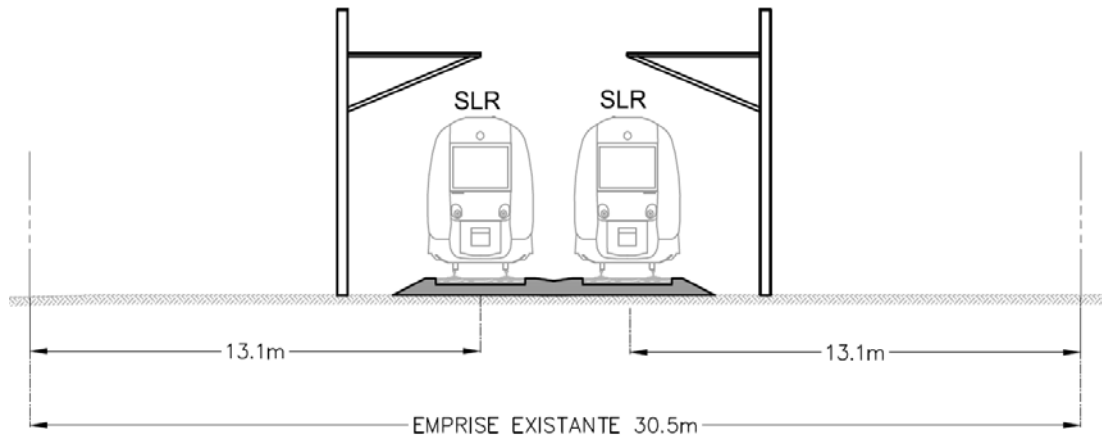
Coupe sur voie ballastée au niveau du sol
